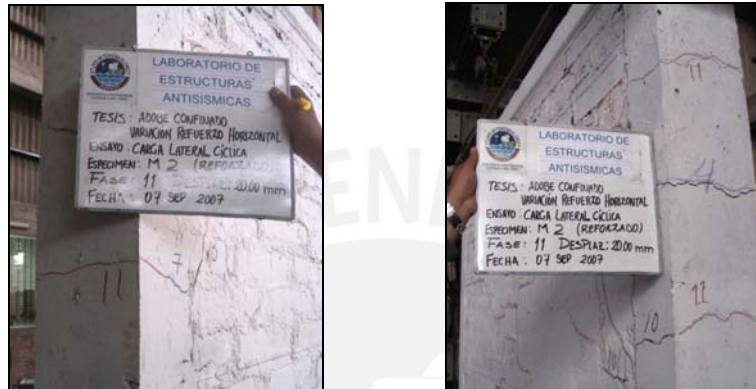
Fisuración de la columna izquierda y derecha.
